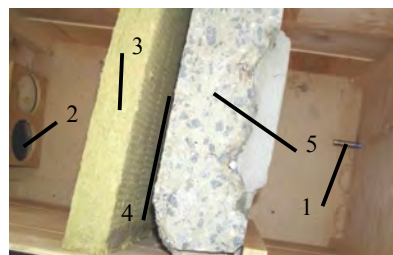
1 – микрофон шумомера; 2 – звуковые колонки; 3 – минераловатная плита; 4 – воздушная прослойка; 5 – бетонная стеновая панель
